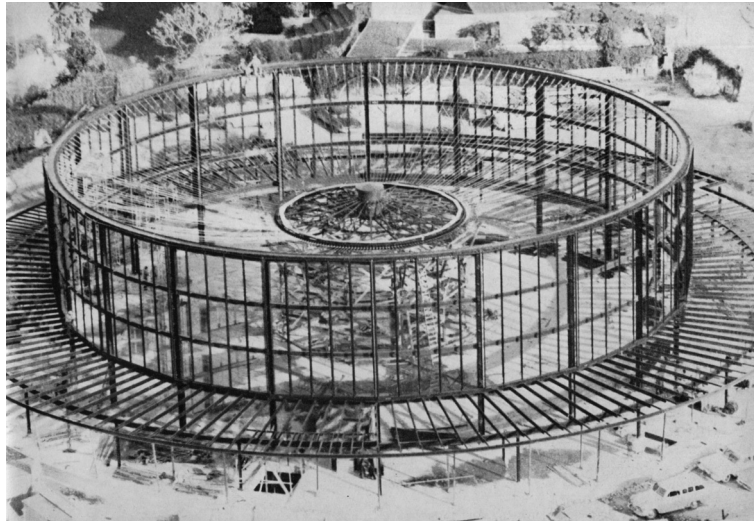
Geschlossenes kreisrundes System mit äußerem Druckring und inneren Zugring im Bauzustand, Villita Assembly Building, Architekt: O'Neil Ford (BNr. 84) [Makowski 1965]
